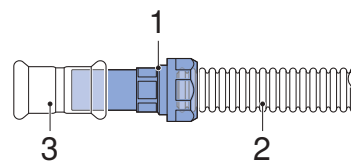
Przyłącze proste, z MasterFix, konstrukcja lekka
